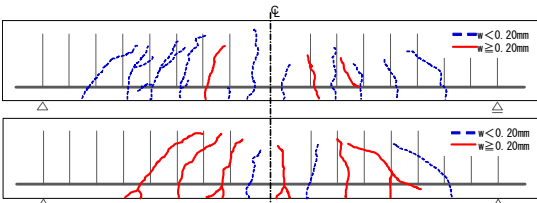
ひび割れ図(上：GP-30，下：OPC-30)
